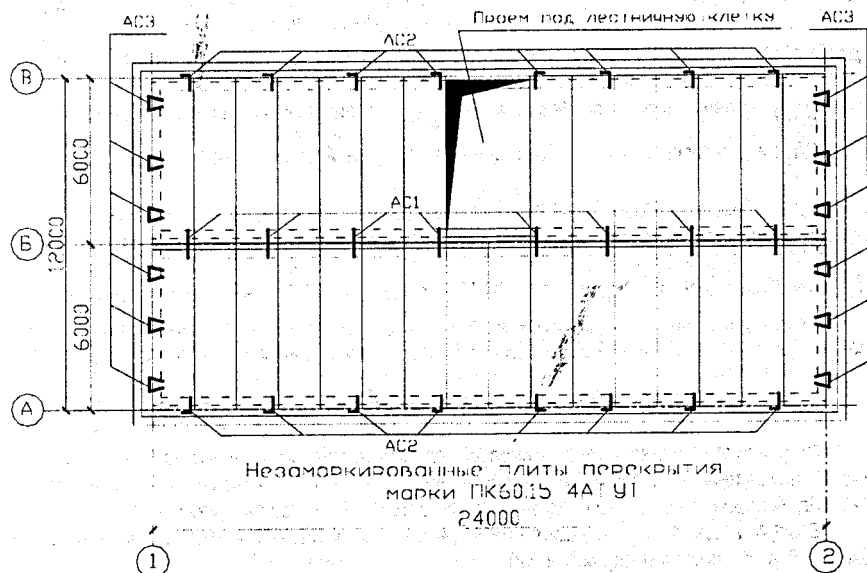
Пример раскладки плит перекрытия над подвалом, фундаменты которого представлены на рис.4.4.1
